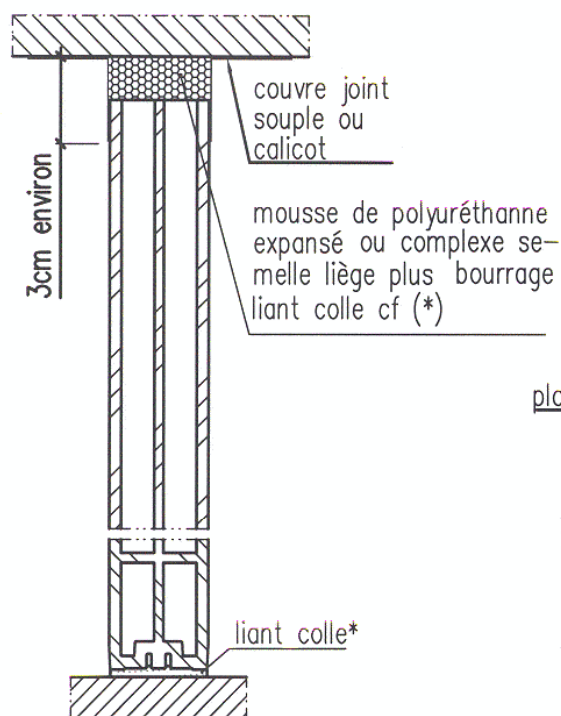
Raccordement en tête et en pied d'une cloison traversant un plafond suspendu
